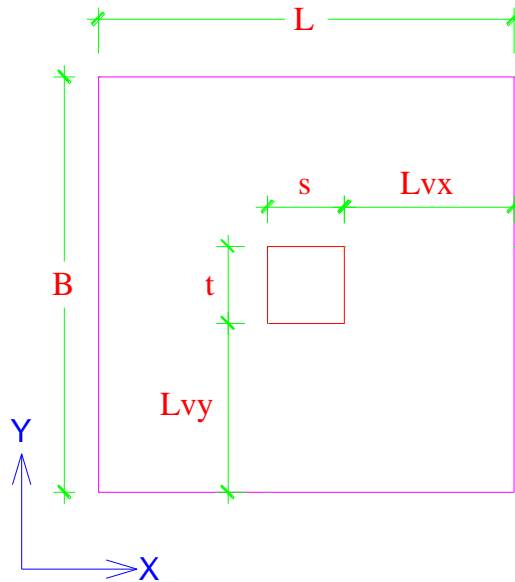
Denominación de longitudes, vista en Planta de la Zapata
